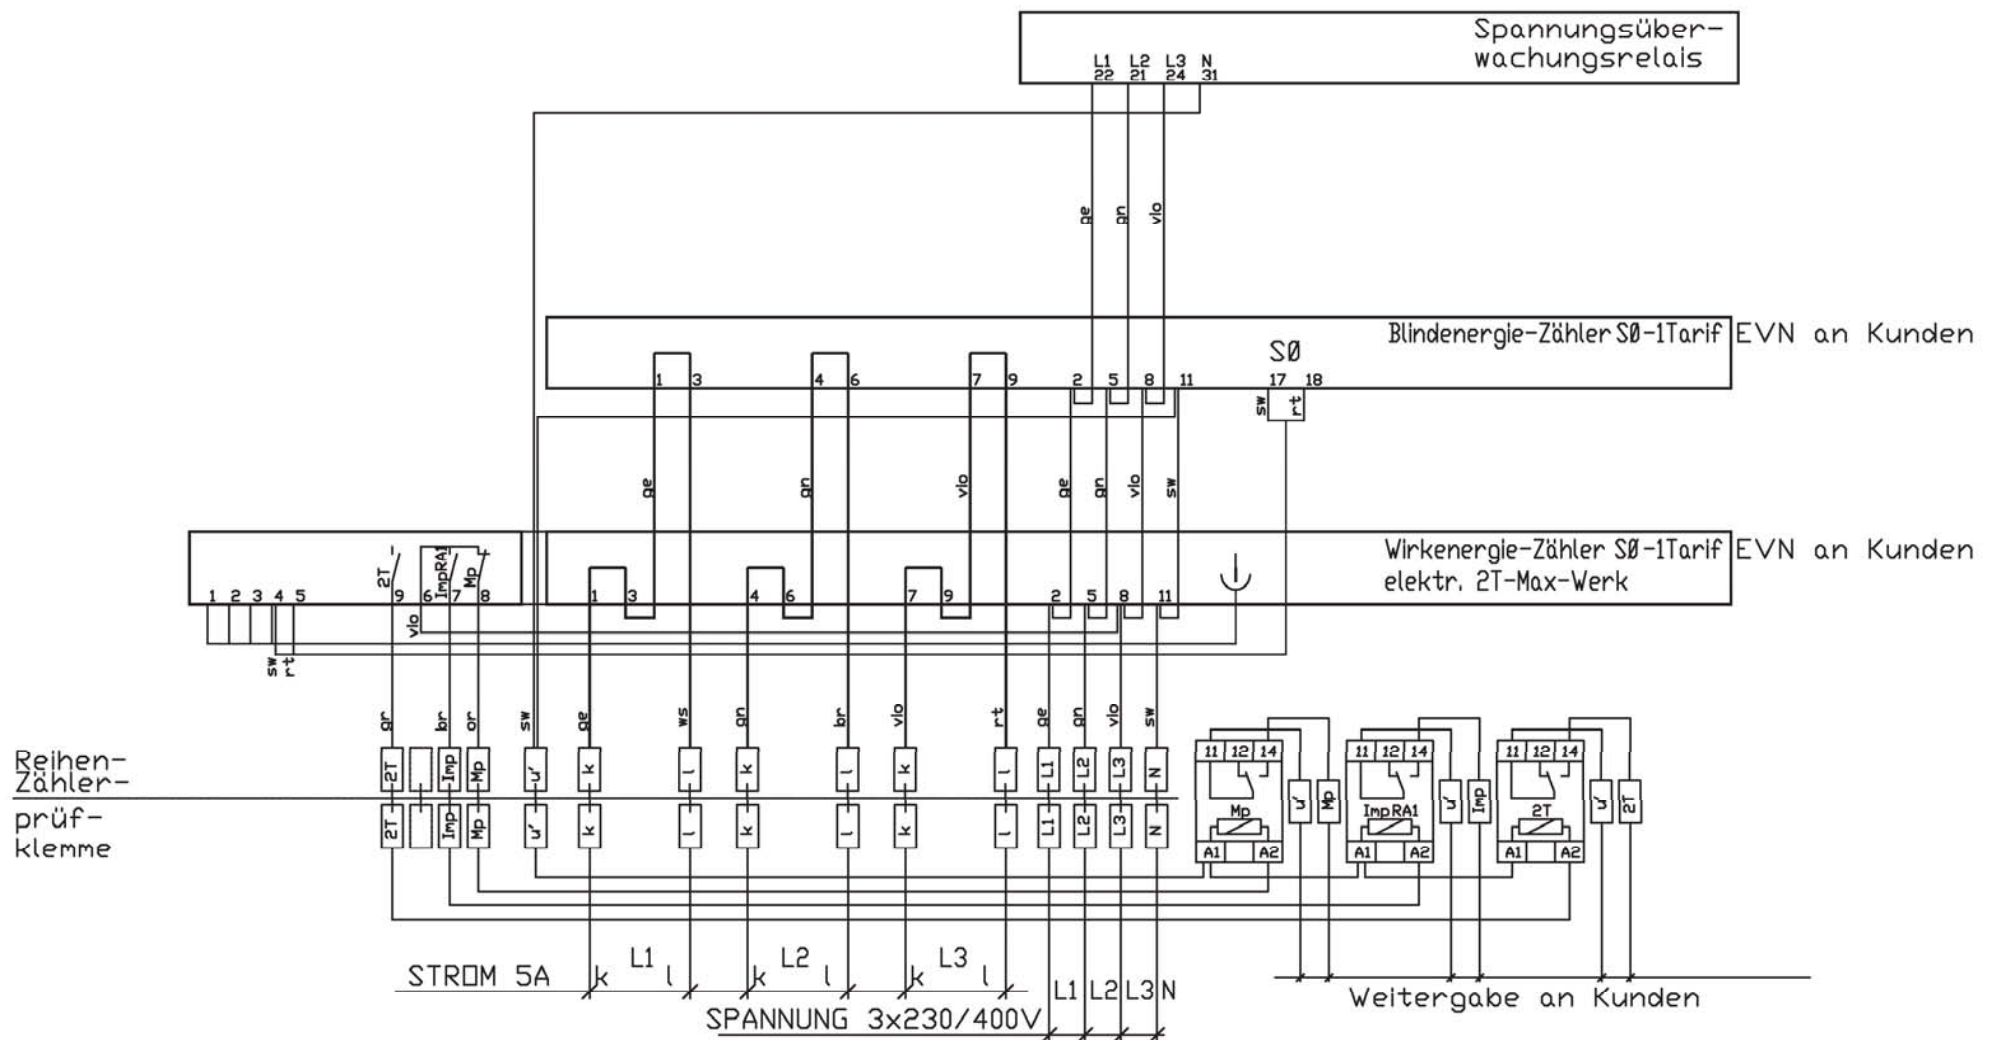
Wandlermesseinrichtung für Verrechnungszwecke - Einschubplattenverdrahtung für Zähler 3x230/400V, 5A mit elektronischem Maximum-Werk
